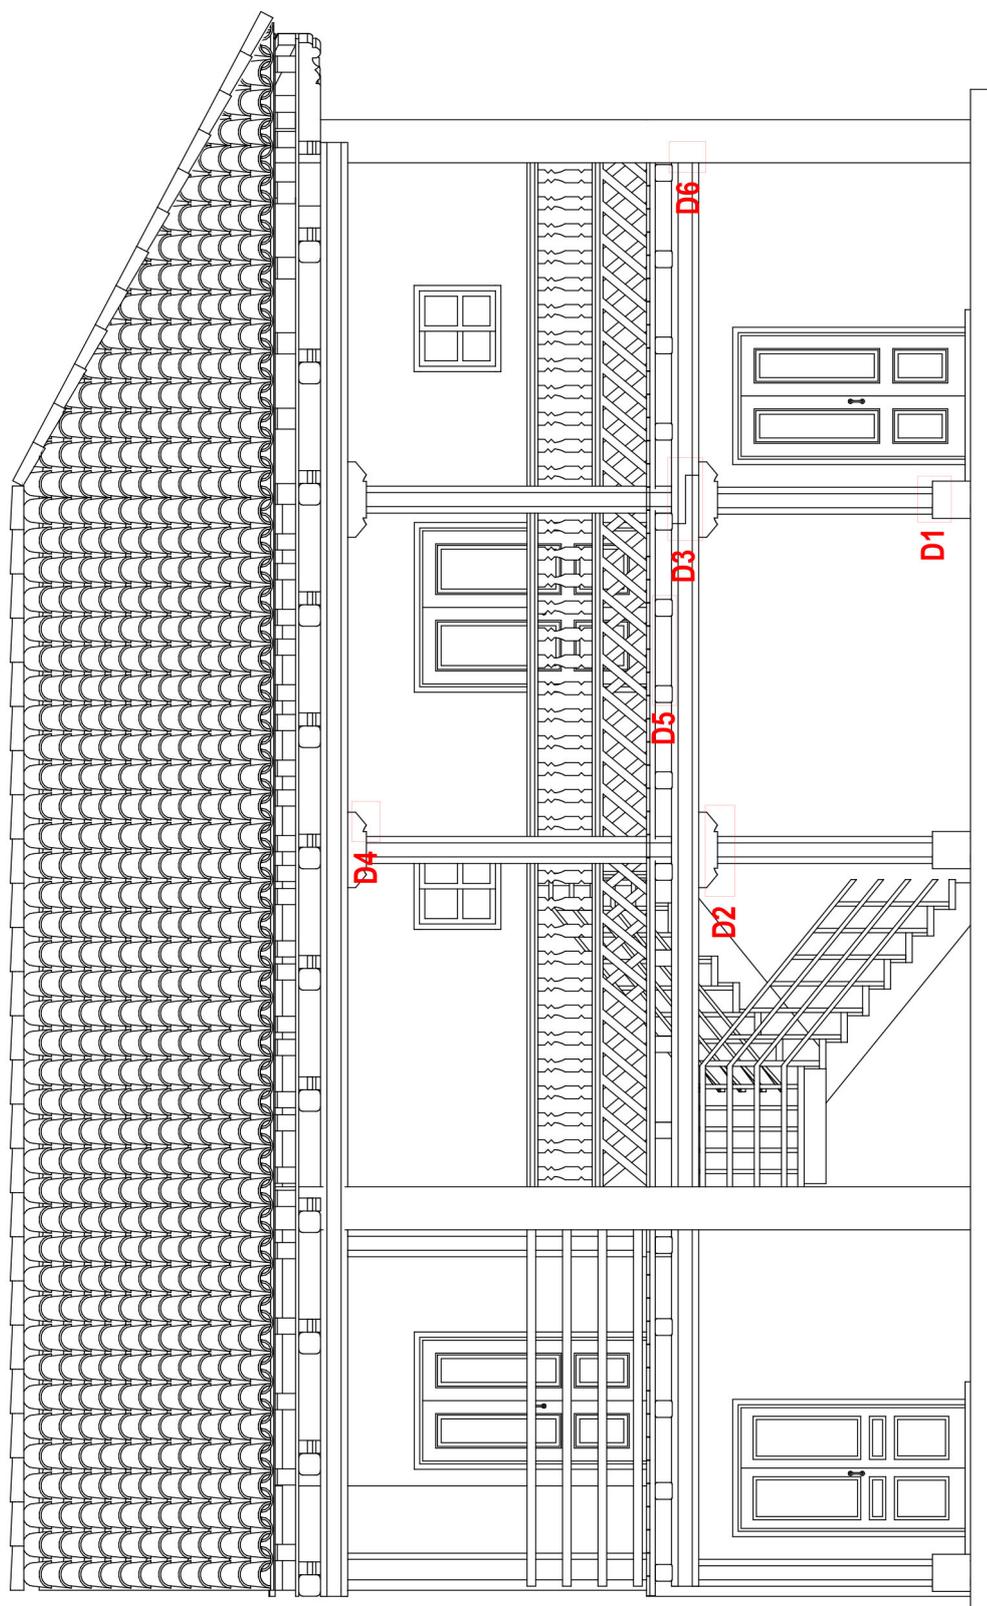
Ubicación de detalles, fachada frontal
